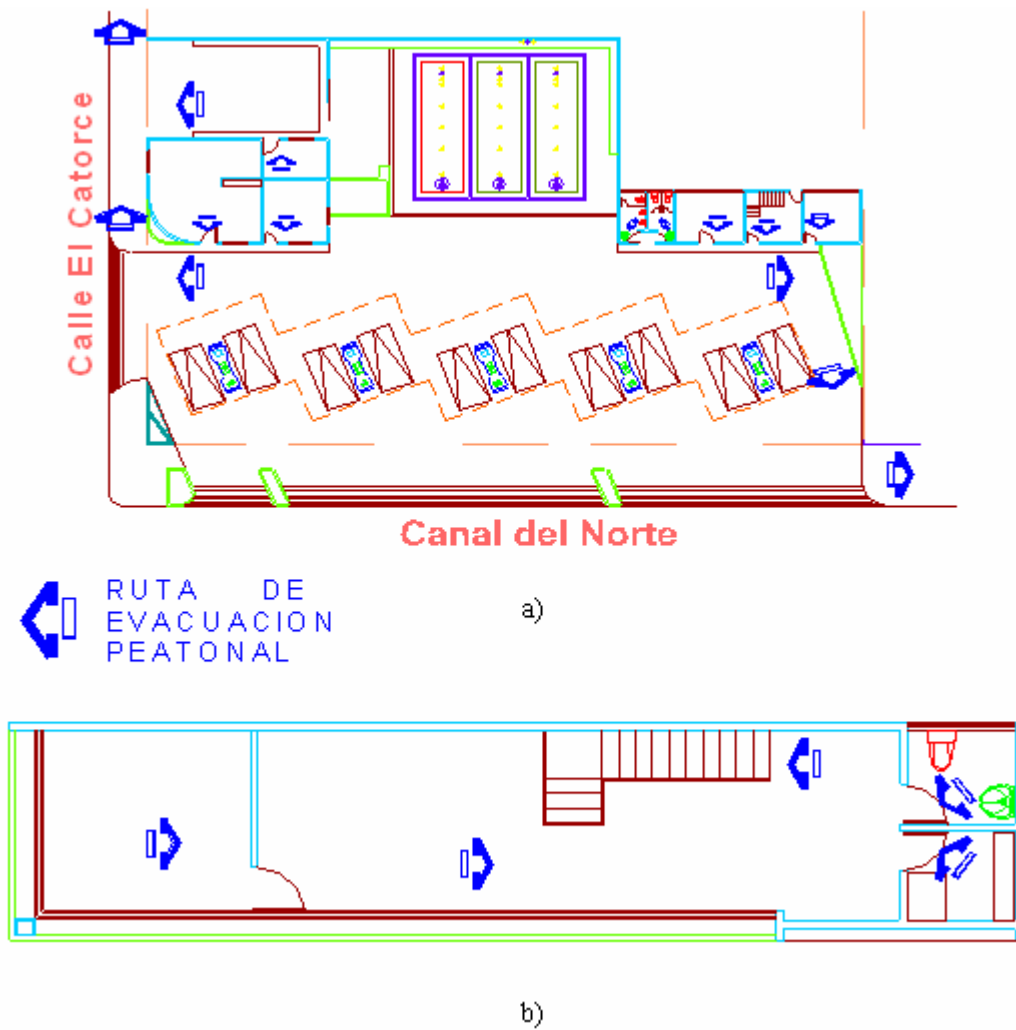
Croquis de rutas de Evacuación Peatonal, a) Planta Baja, b) Planta Alta
